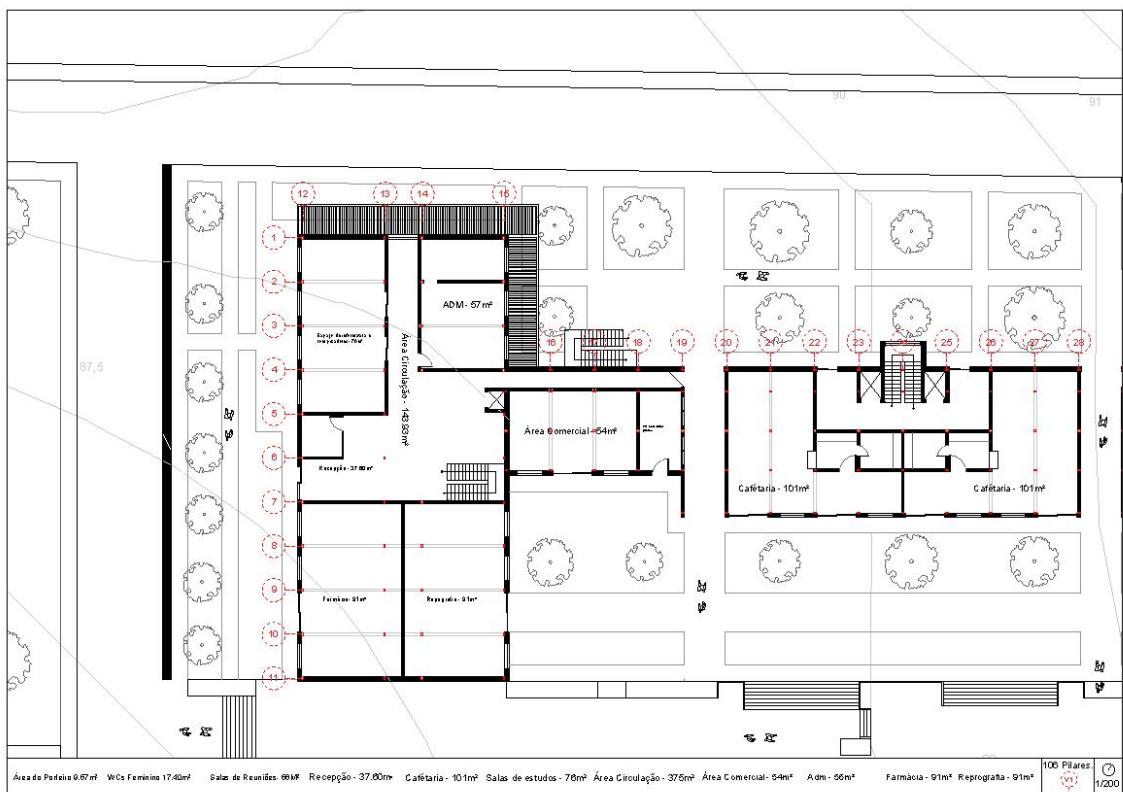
Planta do Térreo 3 Bloco 1/200.
